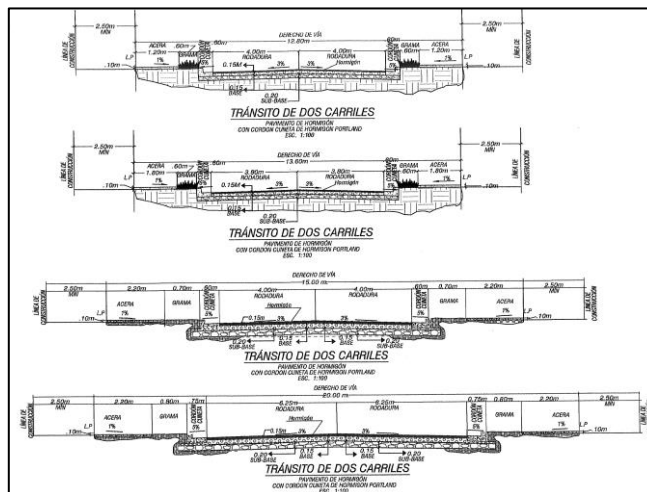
Sección de las calles del proyecto. Fuente: Planos de anteproyecto.
